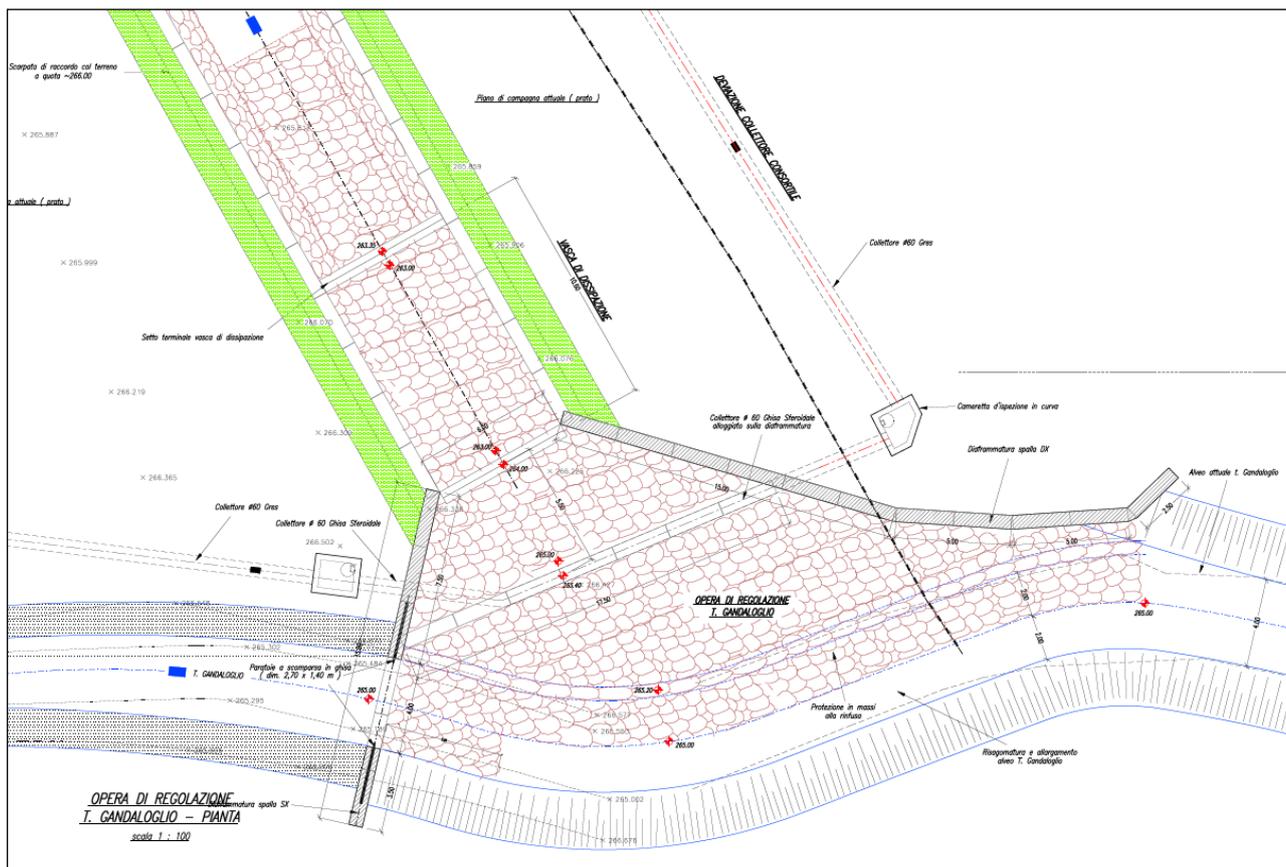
Vista in pianta dell’Opera di regolazione (Progetto Esecutivo Lotto 1)
